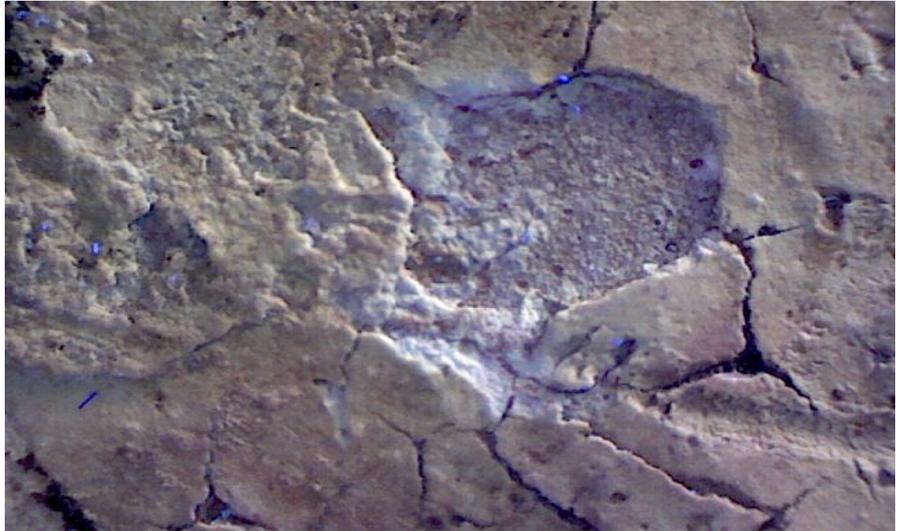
Faltante de preparación perfilado de fisuras y sales.
